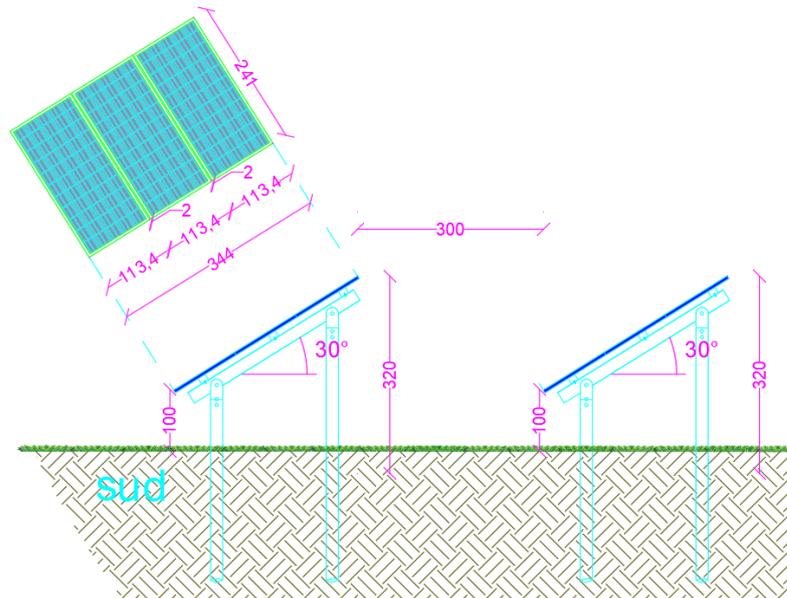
Sezione tipo impianto nella configurazione a sistema fisso
